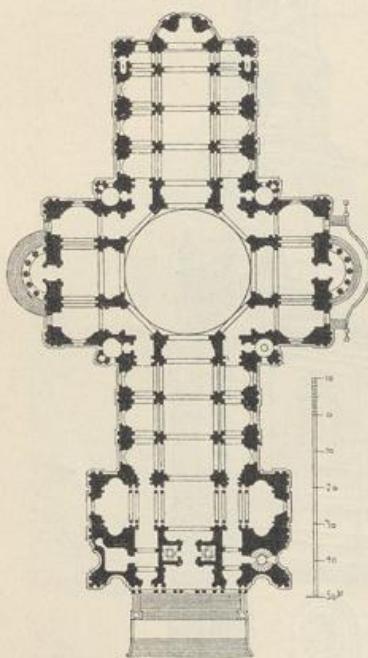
Grundriss der Pauls-Kathedrale zu London
